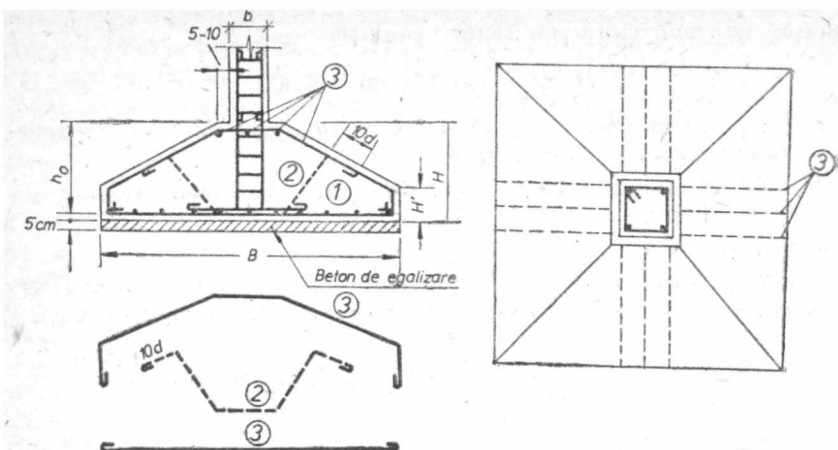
Fundație izolată tronconică din beton armat pentru un stîlp.
